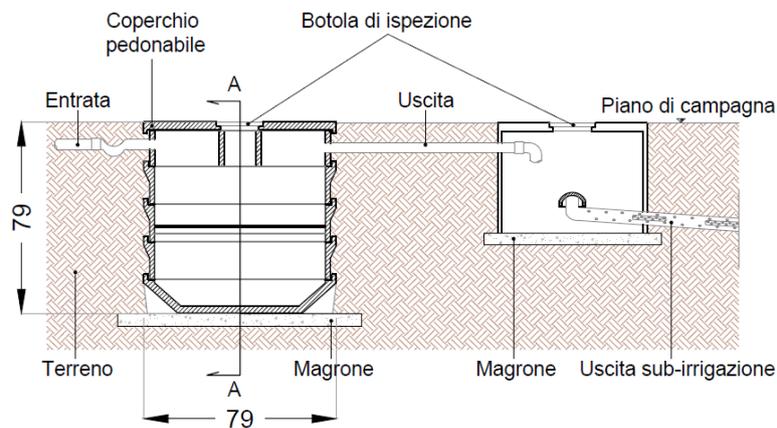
Sezione tipo della fossa Imhof a servizio della Control Room, misure in cm
